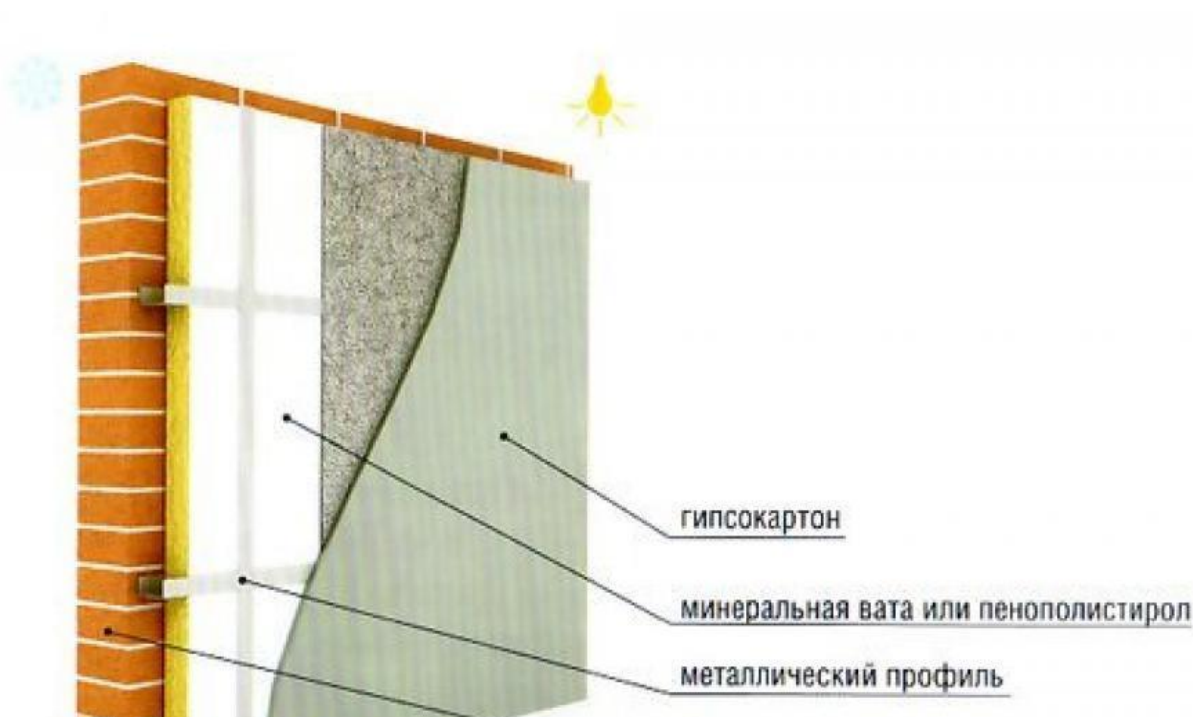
Утепление стен изнутри теплоизоляционными плитами и гипсокартонными листами
